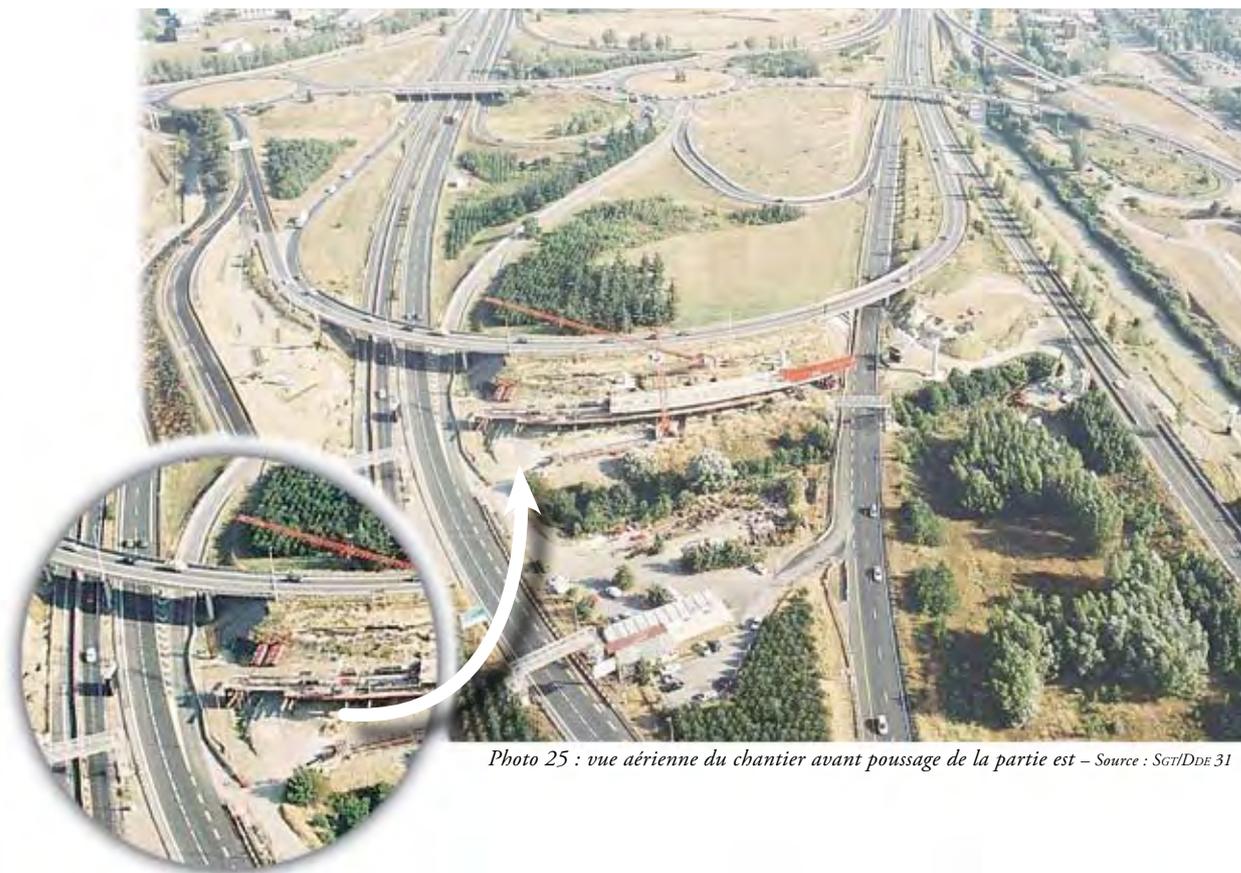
vue aérienne du chantier avant poussage de la partie est – Source : SGT/DDE 31
